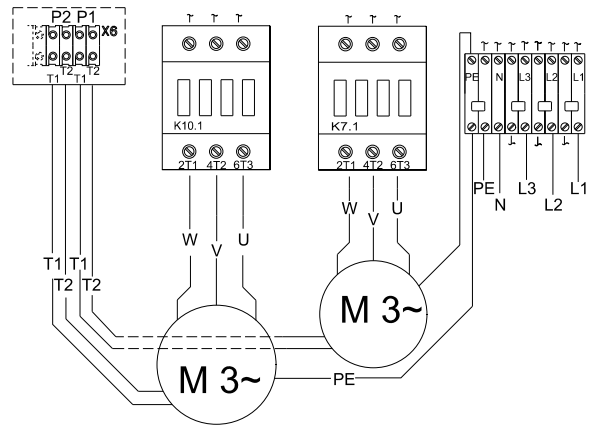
Схема соединений для Multilift MD/MLD.22.3.4 с трехфазным электродвигателем с контакторами
